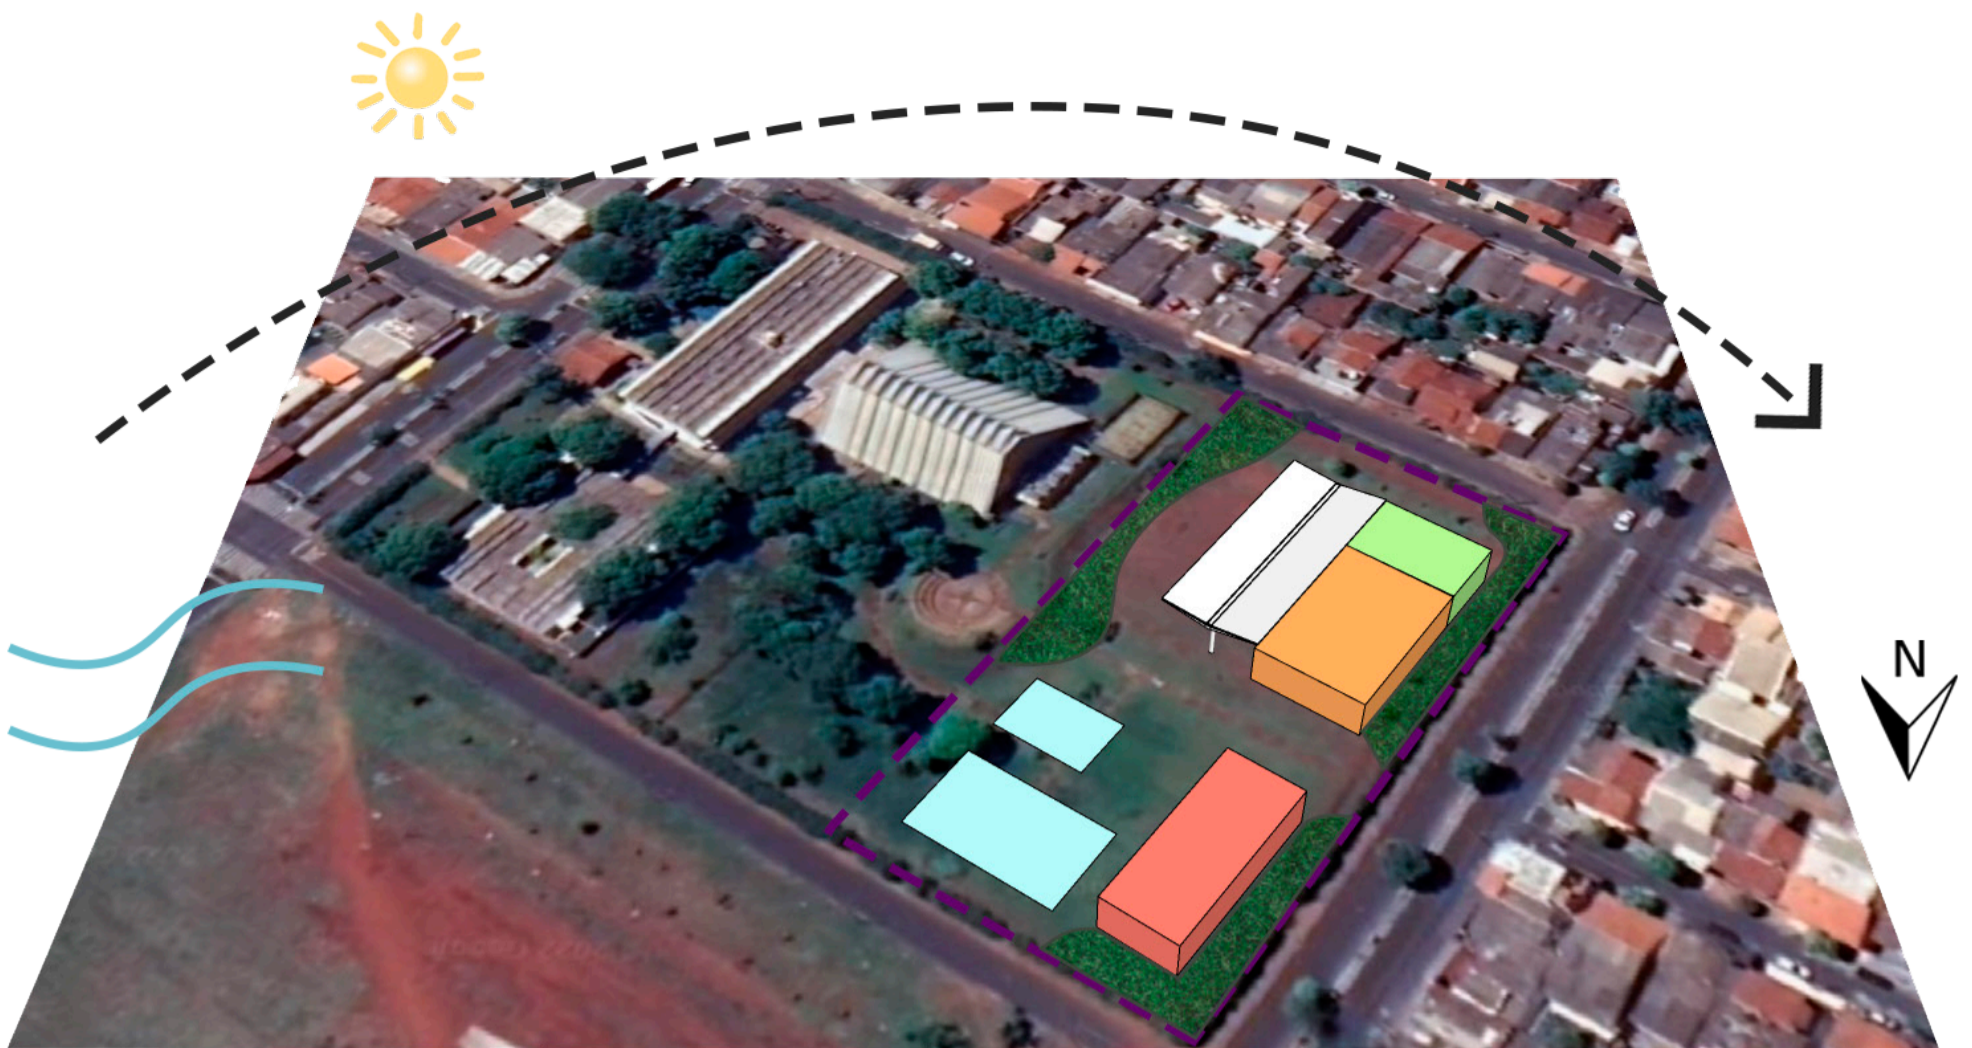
Proposta preliminar de implantação do projeto no bairro Guarani.
